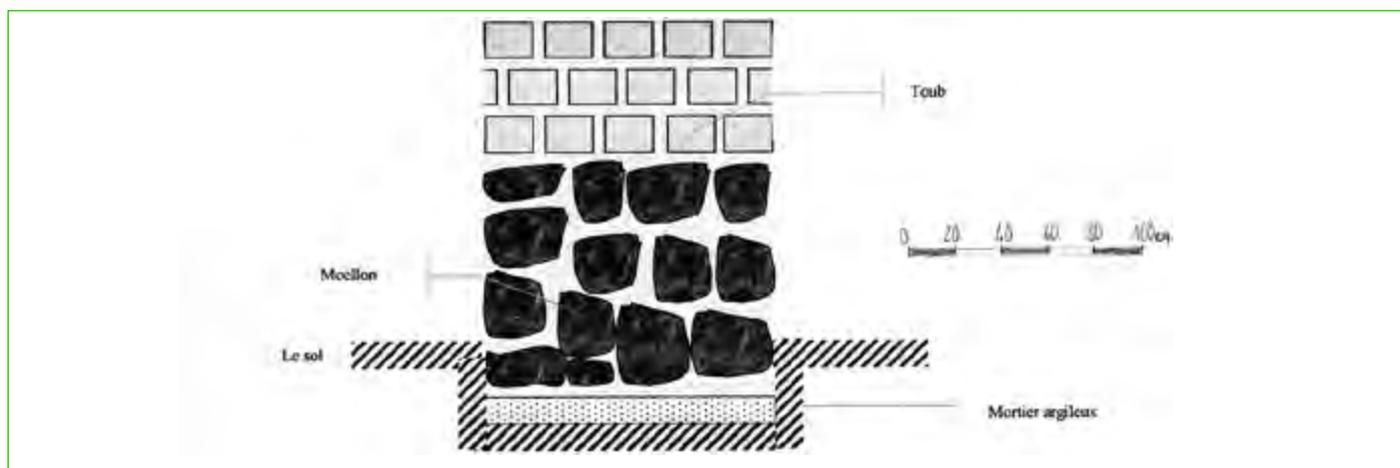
Détail de construction d'un mur de *toub*. Dessin de l'auteur.
